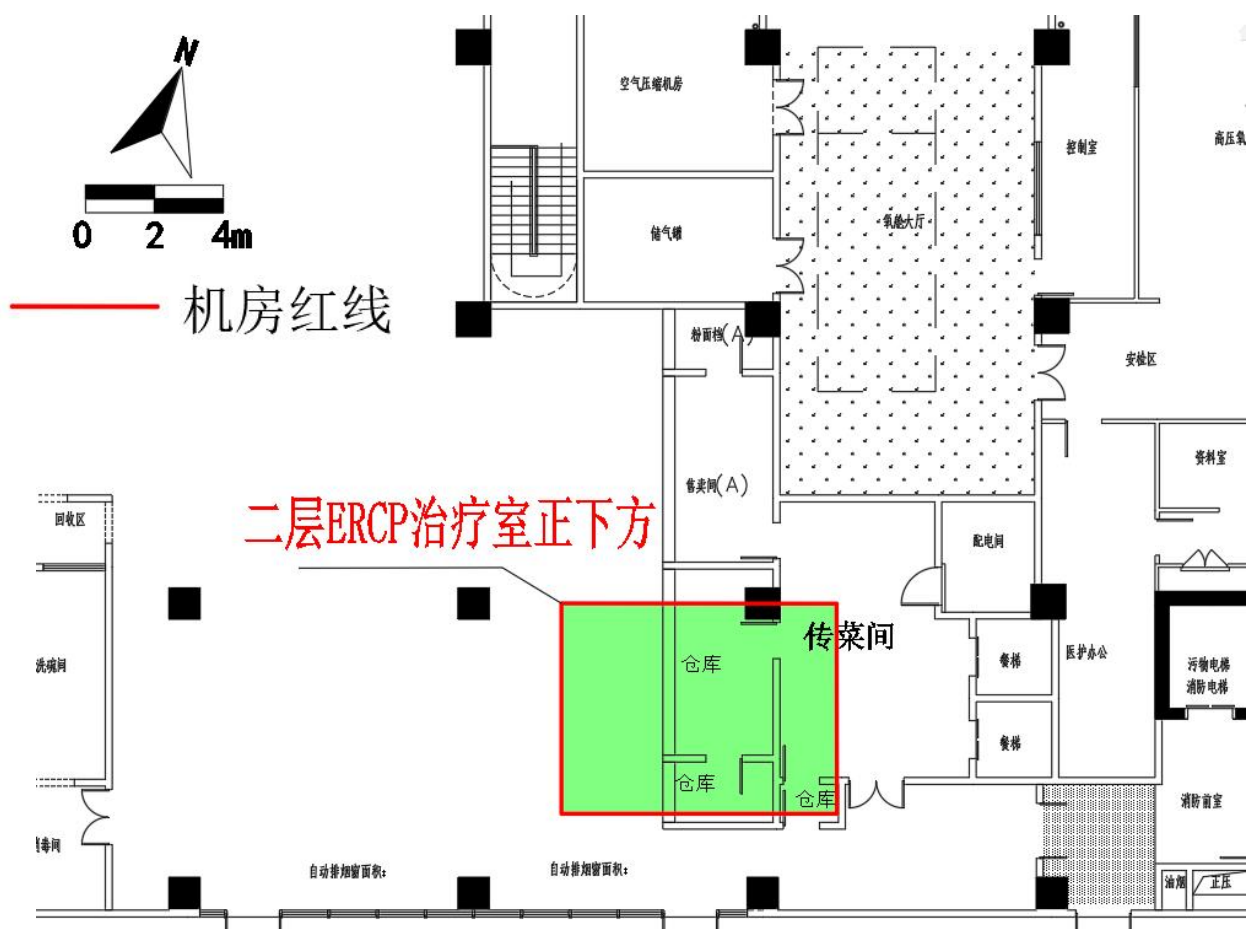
本项目 ERCP 治疗室下方楼层（一层）局部平面布置示意图
